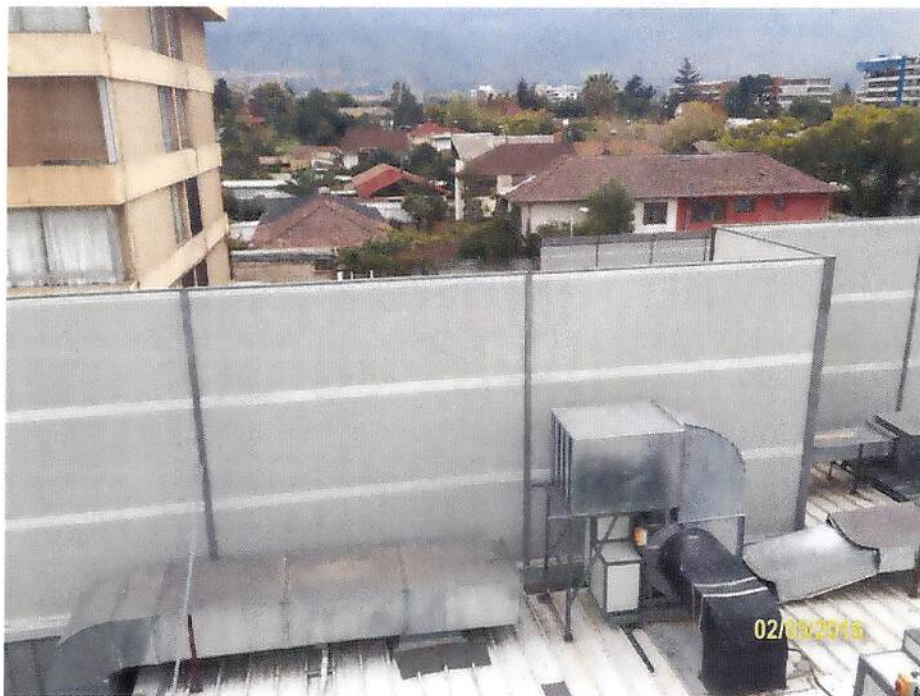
Barrera acústica perimetral en la cubierta + Barrera parrilla de condensadores.
